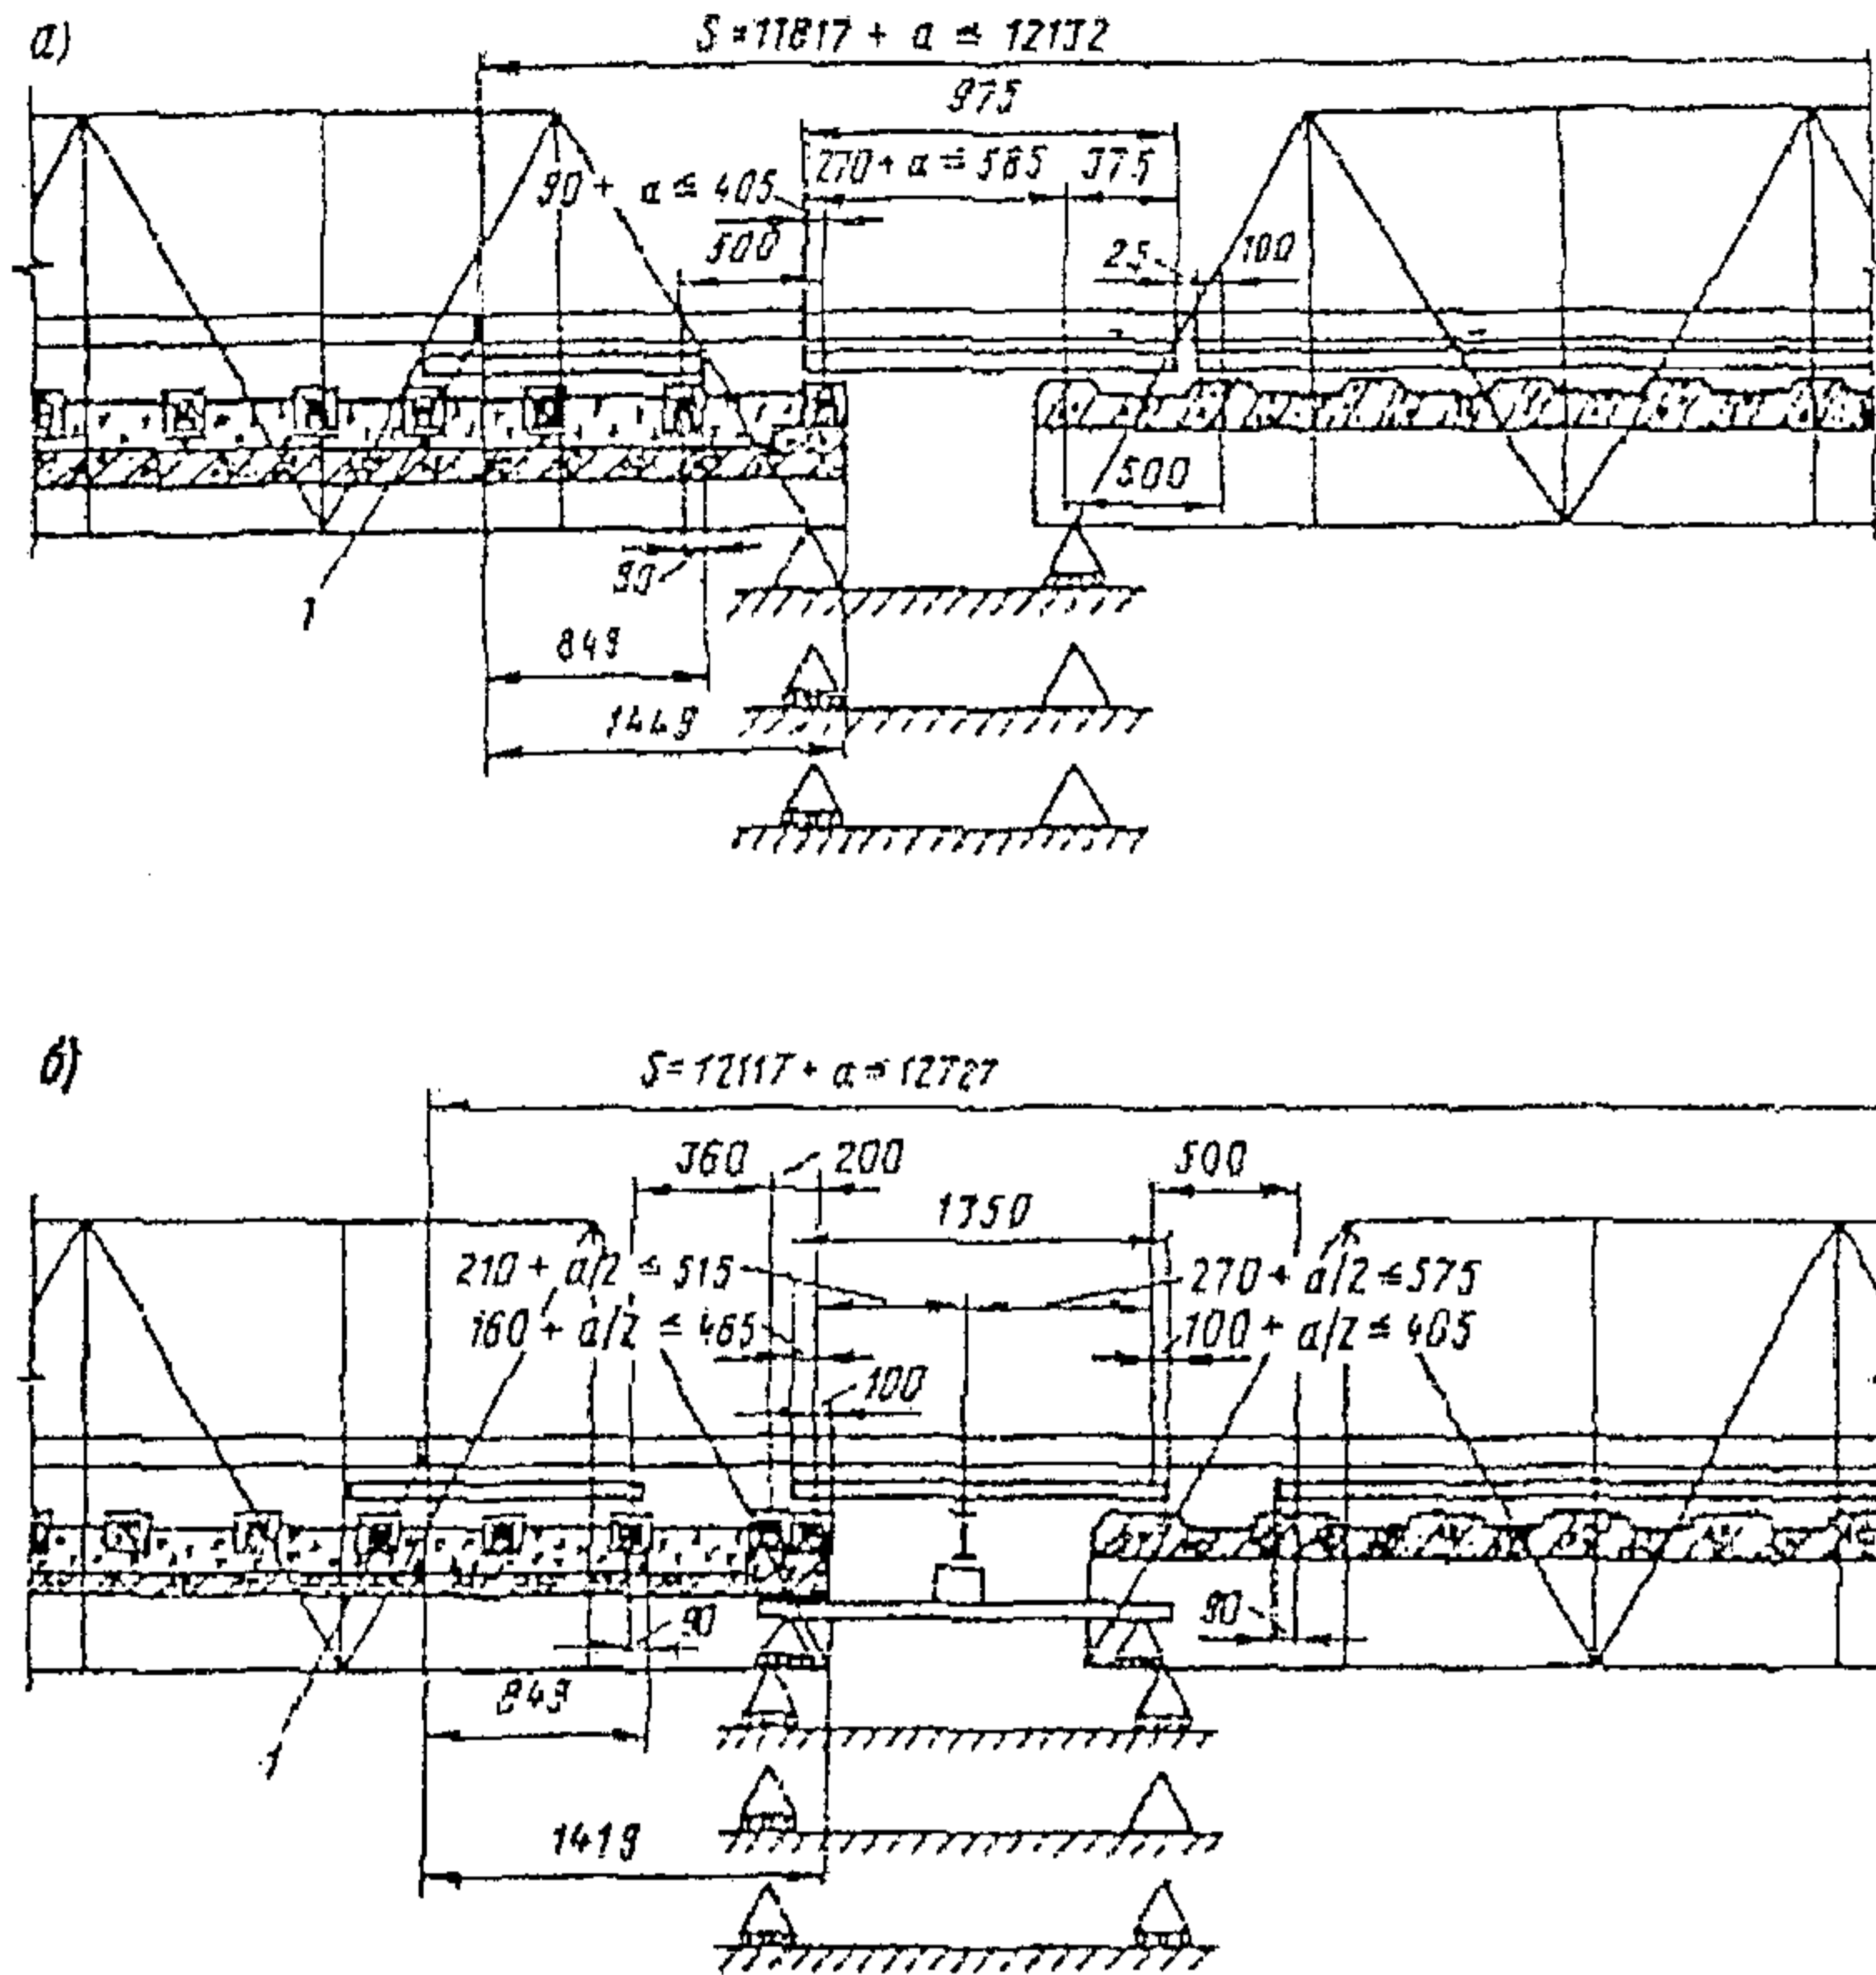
Схемы установочных размеров для укладки уравнительного прибора Р-65 на мостах с ездой на балласте на деревянных шпалах и на железобетонных плитах при перемещении подвижных концов пролетных строений в интервале:
